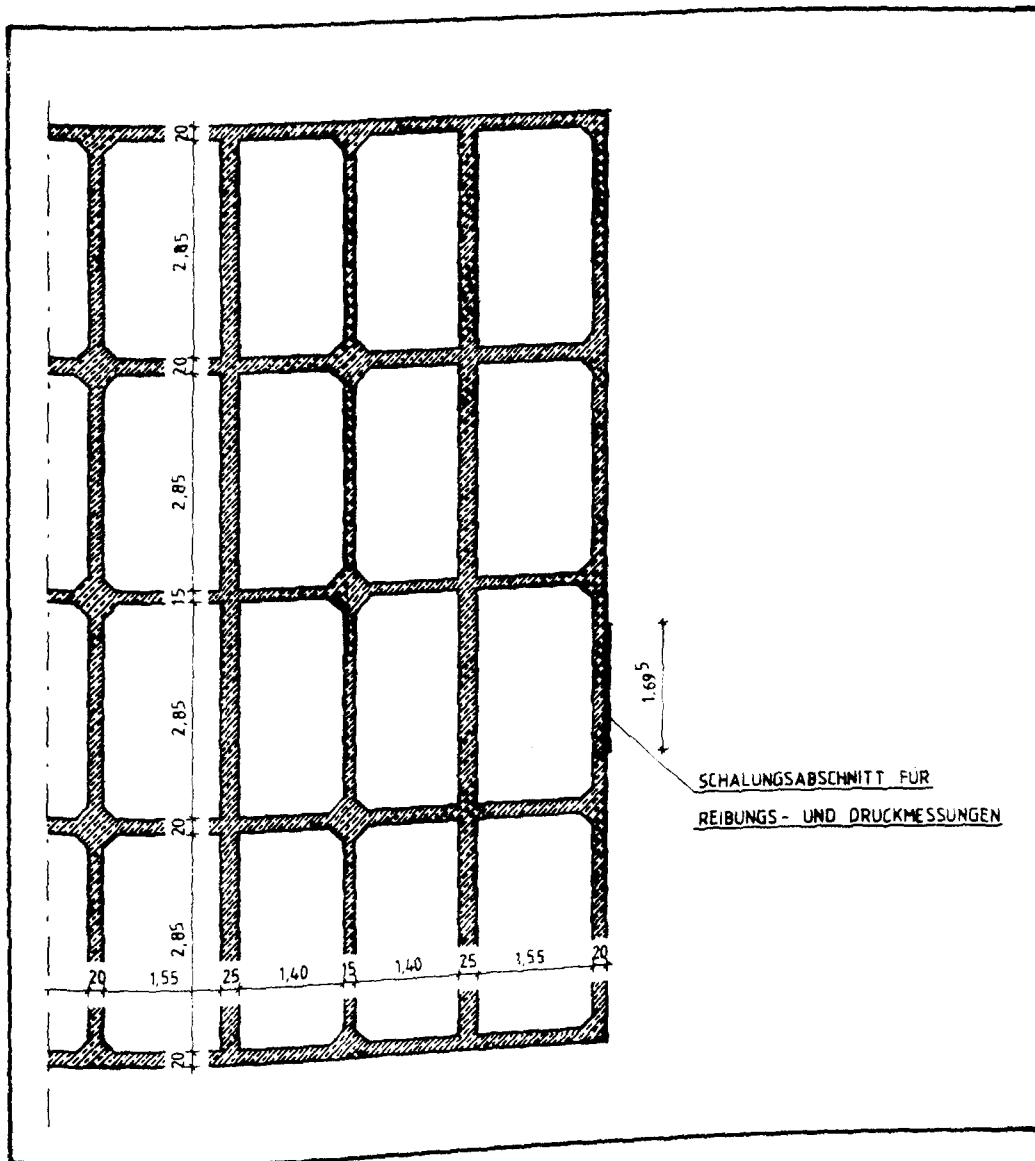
Ausschnitt aus dem Grundriß des Silos,
